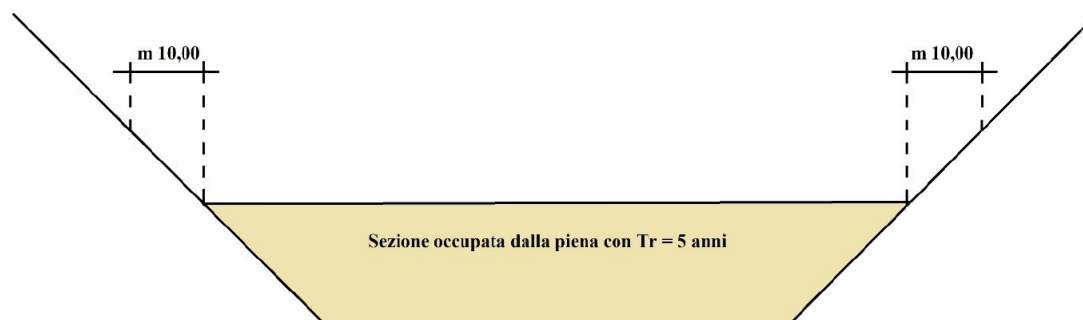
Particolare sezione idraulica - DSG 119/2022
